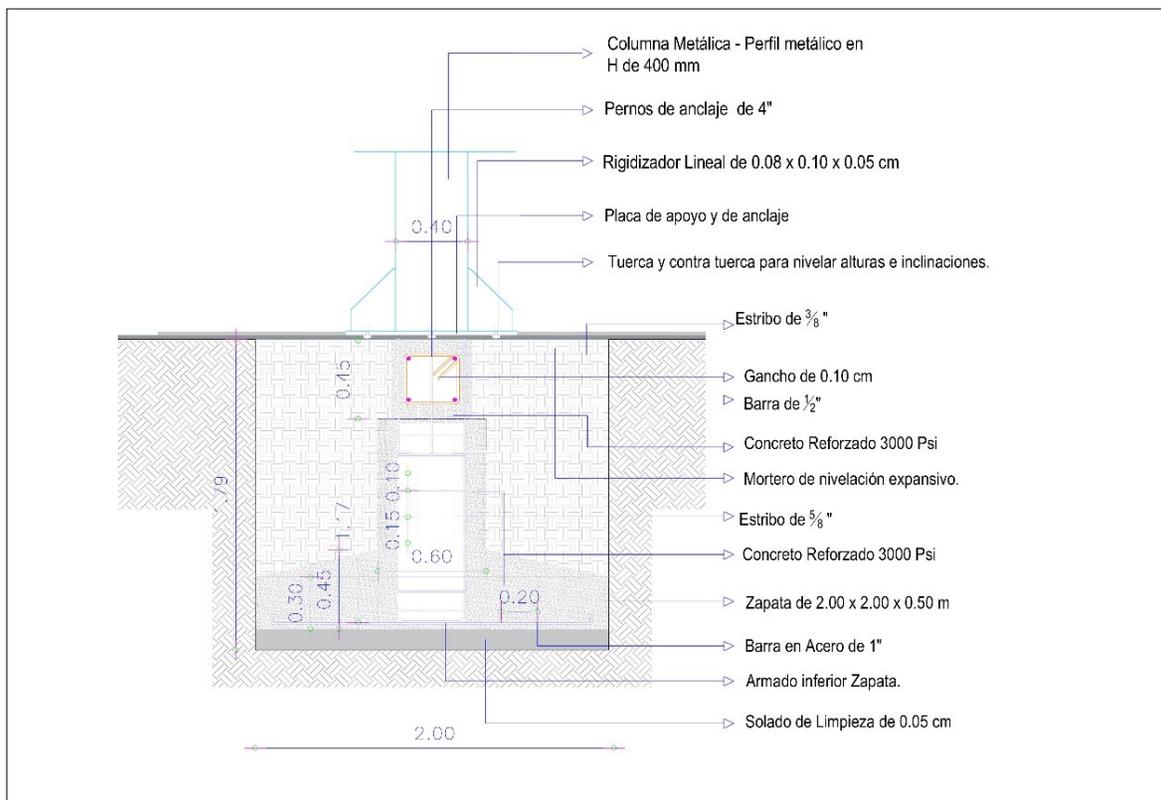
Detalle constructivo de cimentación, Fuente: elaboración propia.
